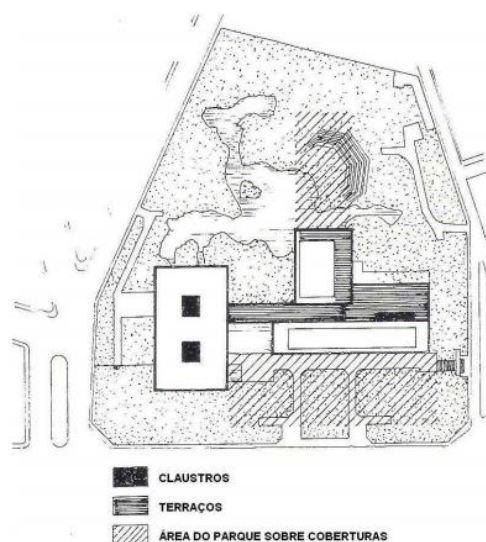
Planta da Gulbenkian com as zonas verdes sobre cobertura (Costa, 2010).
